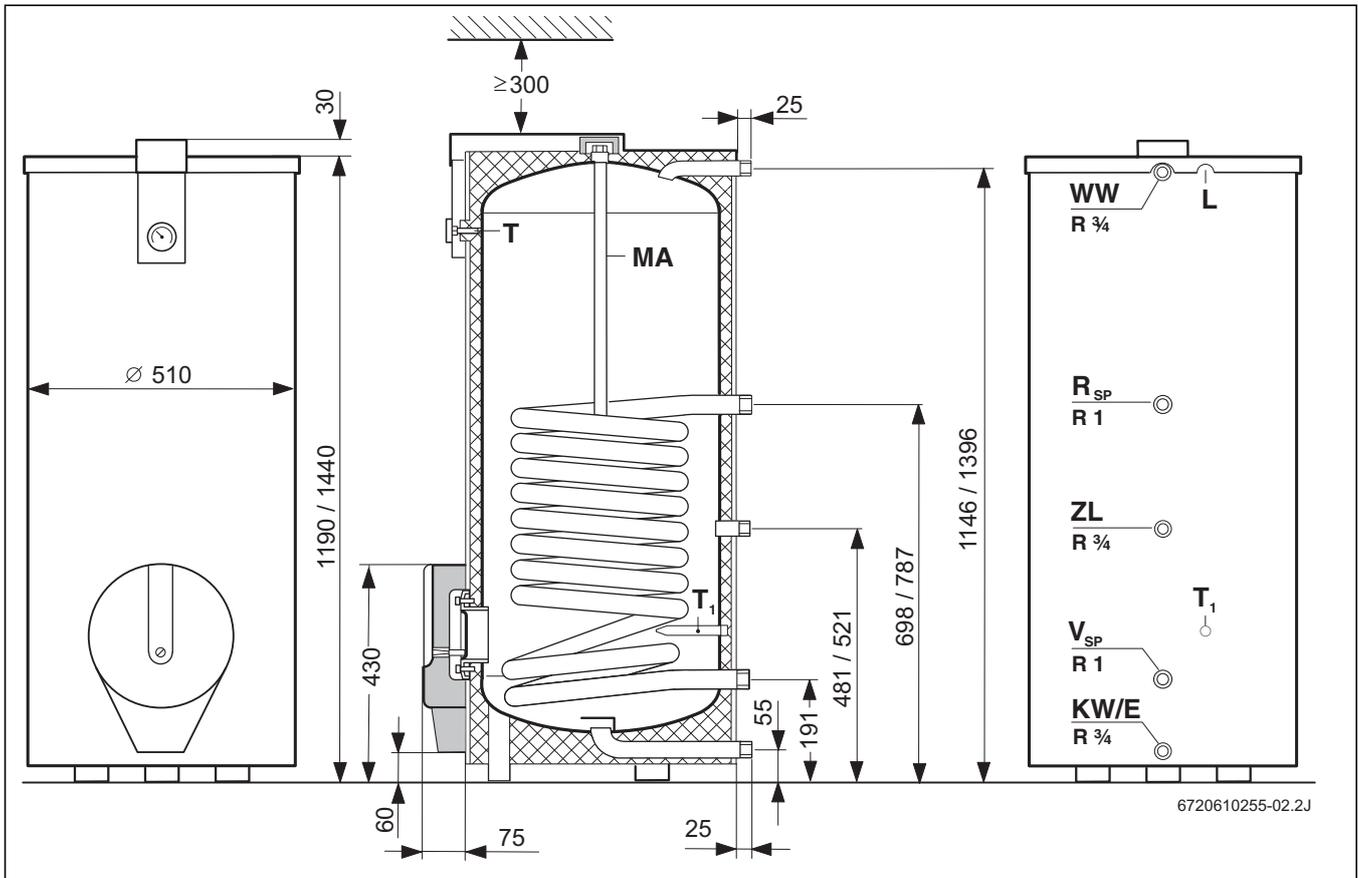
Bau- und Anschlussmaße SK 160/200-5 ZB
